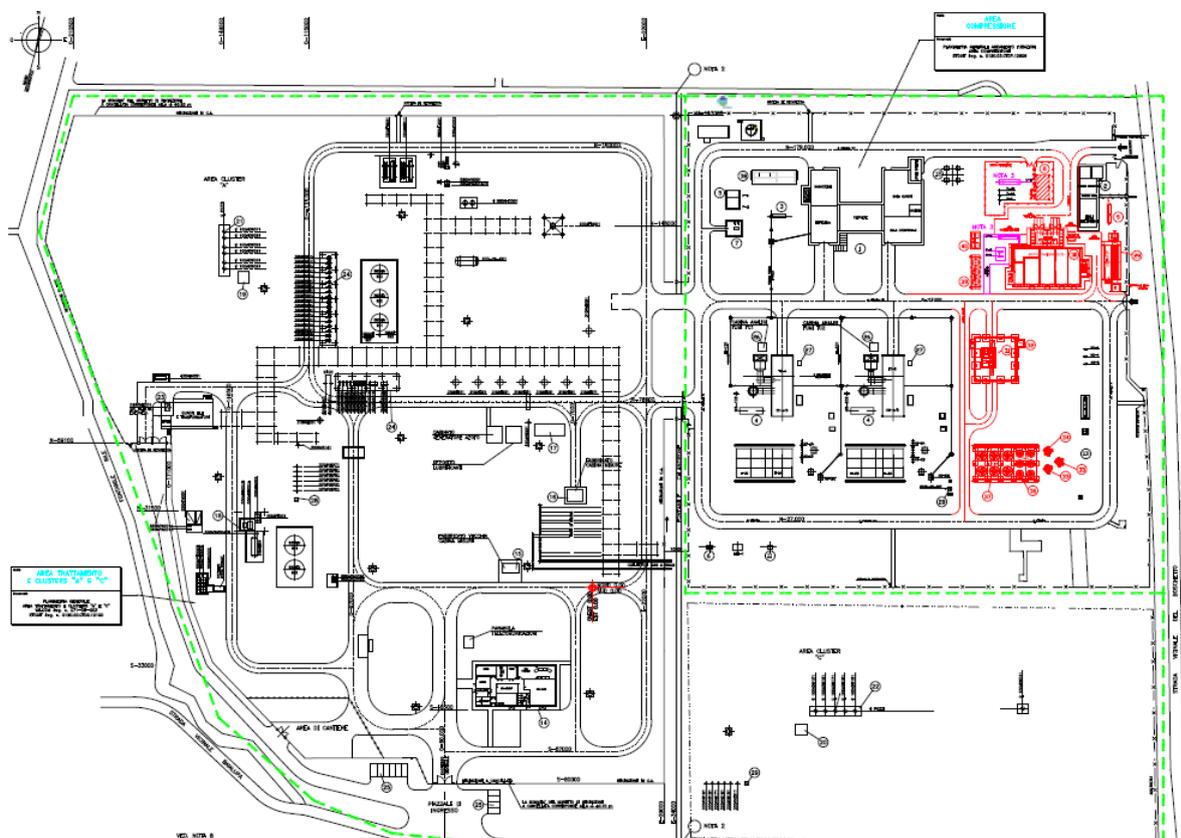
Stralcio della planimetria generale della Centrale di Settala con indicazione in rosso delle modifiche in progetto
